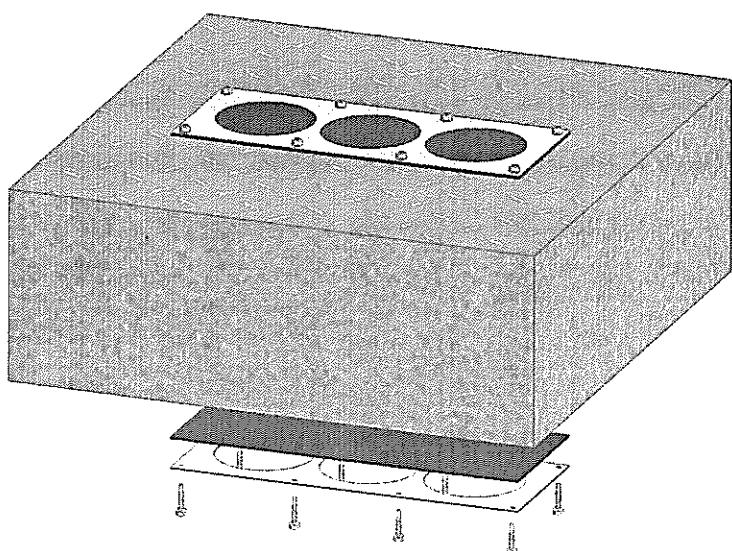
Устройство прохода кабелей через перекрытие пола
